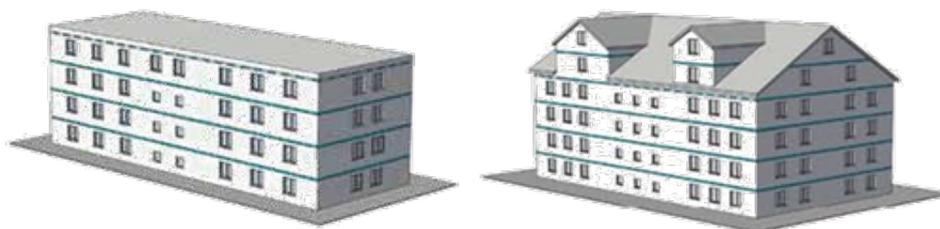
disposición de franjas cortafuegos perimetrales en edificios con cubierta plana e inclinada (fuente: VAWD)
